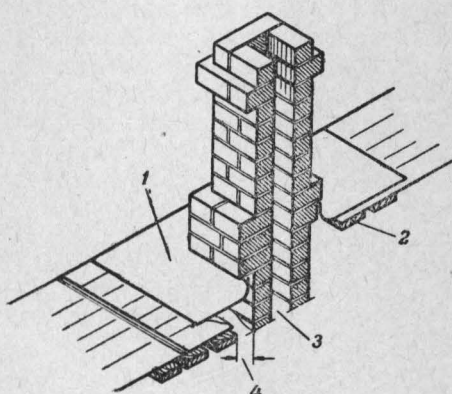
Устройство покрытия из кровельного железа вокруг дымовой трубы при тесовых, щепных, гонтовых и драночных кровлях:
